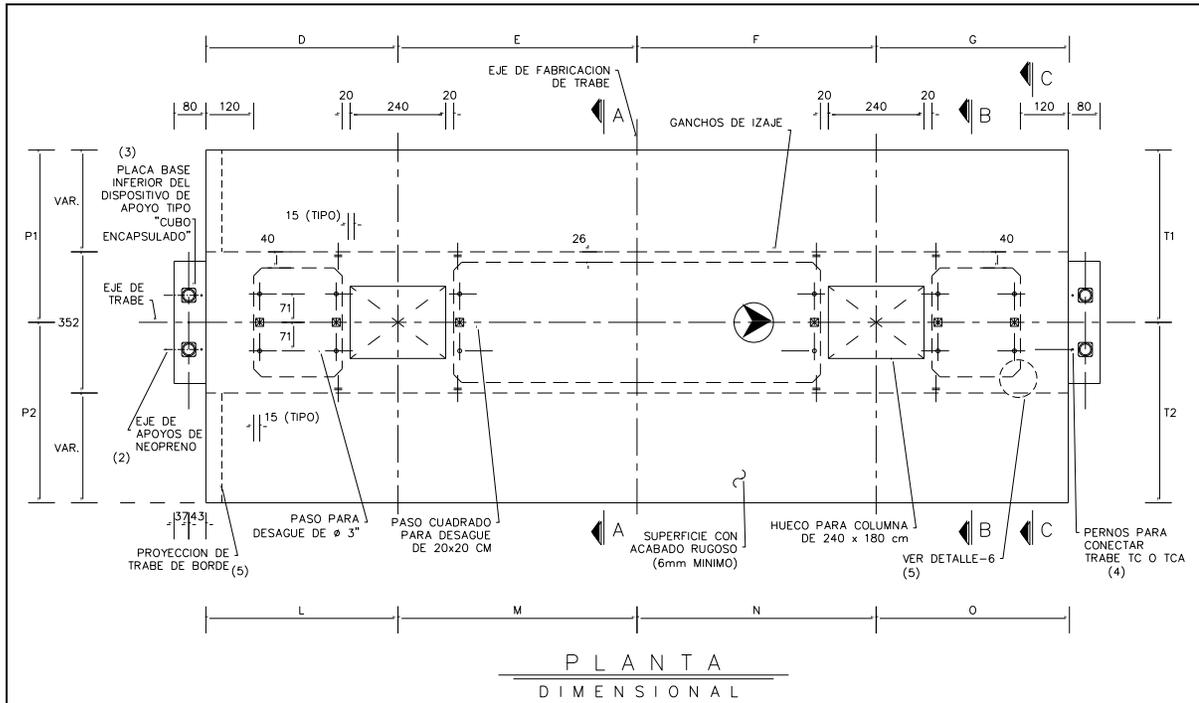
Vista en planta de Trabe ATA9-2, perteneciente a la zapata A10 - A11. Acotaciones en cm
